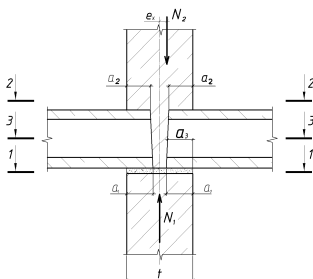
Комбинированный горизонтальный стык стен из монолитного железобетона
